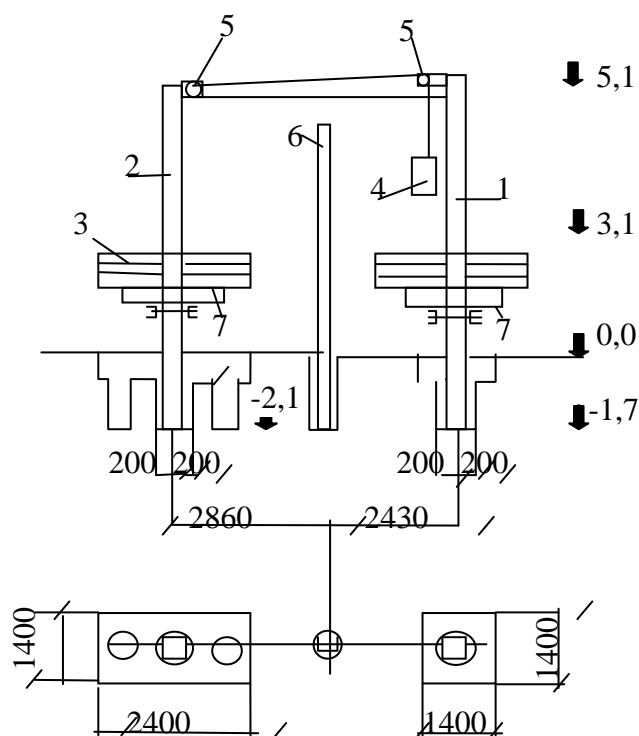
Конструкция свай-колонн и схема приложения нагрузок:
